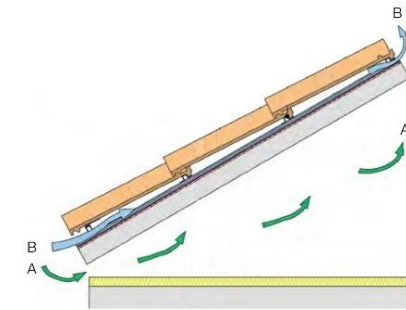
Cubierta ventilada (fría), con soporte resistente horizontal
